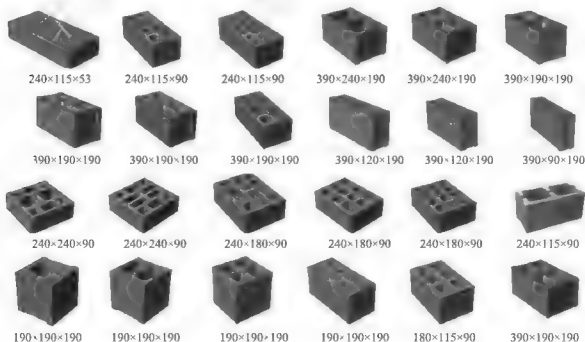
常见砌体材料的尺寸 (mm×mm×mm)
